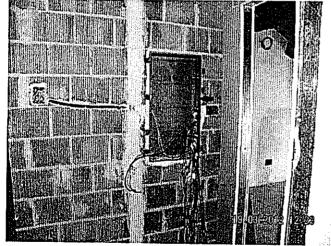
Secondo piano: Ballatoio scale- Quadro elettrico
